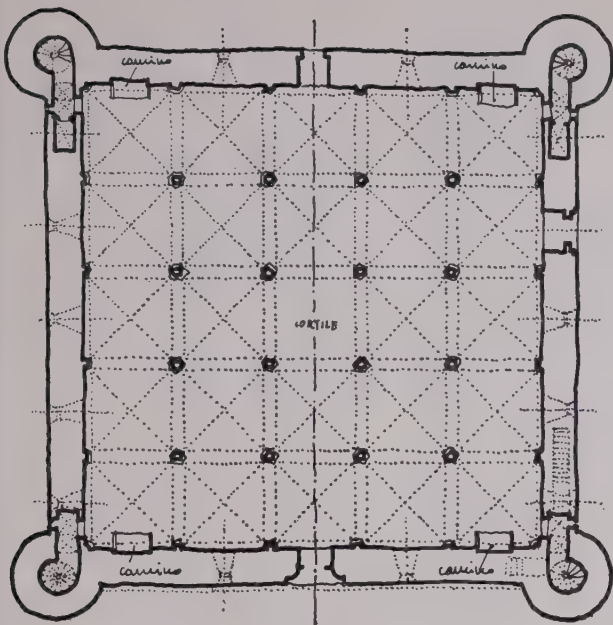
Siracusa, Castello Maniace: Planimetria
